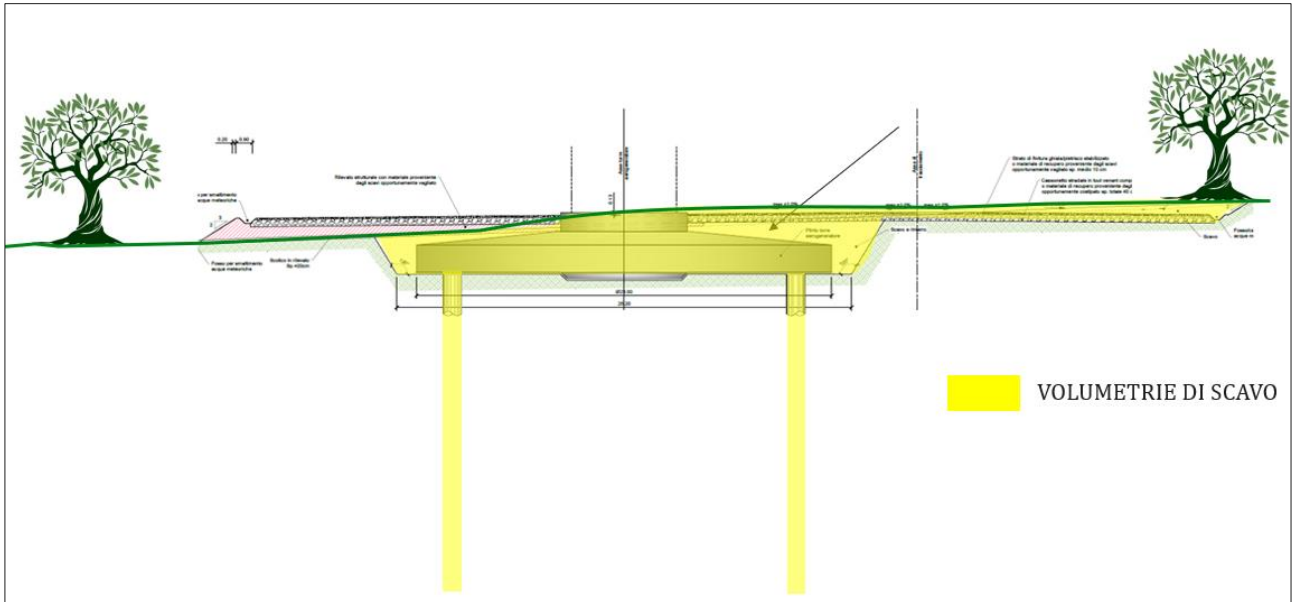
PLINTO DI FONDAZIONE DEGLI AEROGENERATORI
